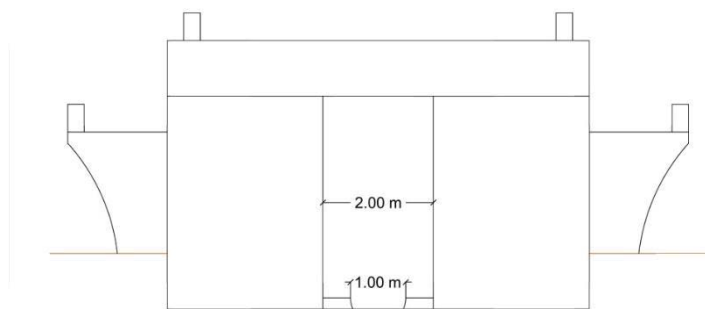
Corte transversal na posição PK0+025 onde é possível ver a secção do canal da ribeira
